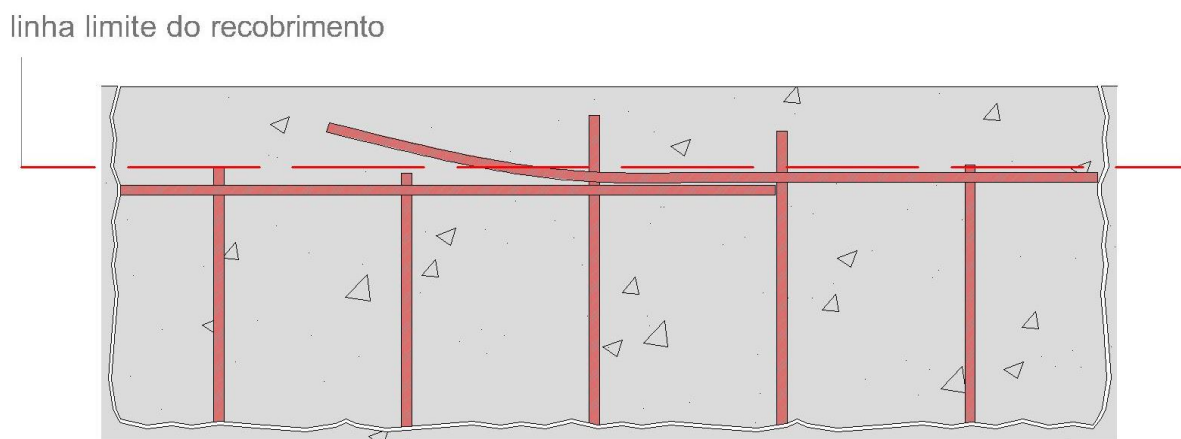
Esquematização da colocação das armaduras apresentado na Figura 4.40
